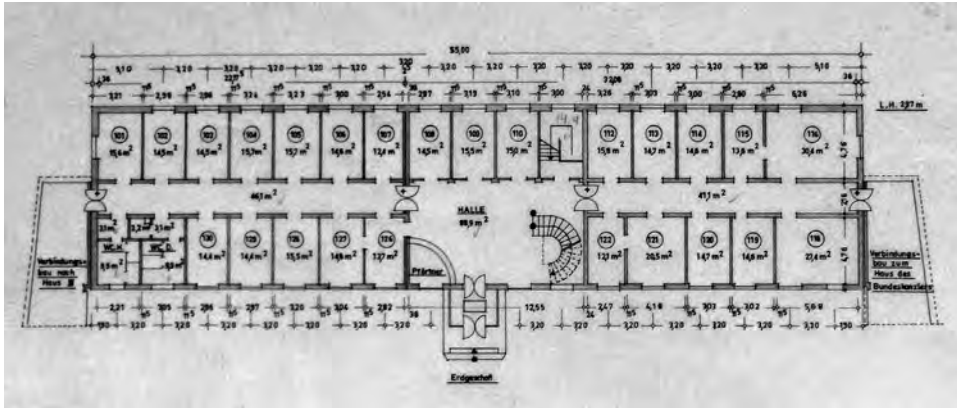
Grundriss Haus II, Erdgeschoss.
